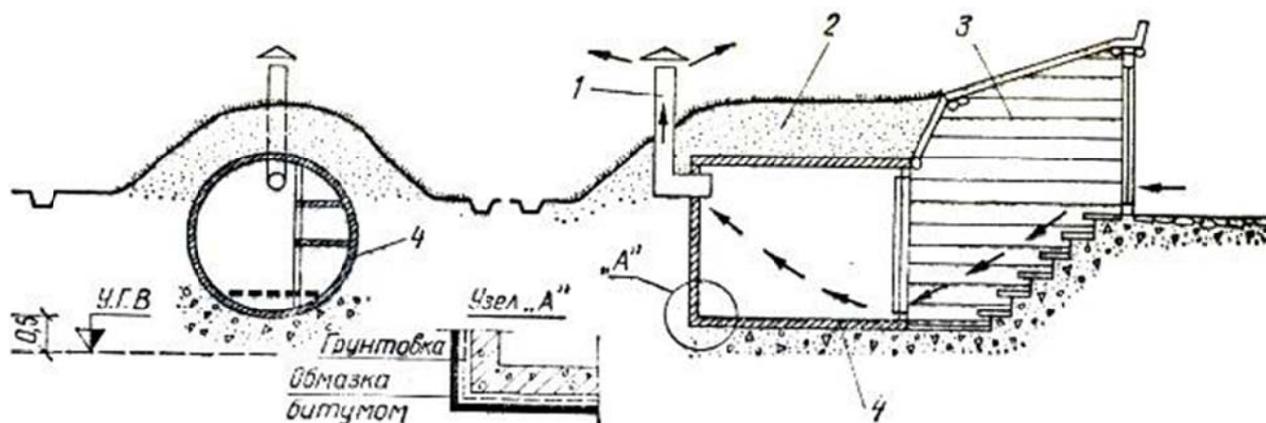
Погреб из железобетонных колец: 1 — вытяжка; 2 — обваловка грунтом; 3 — входной тамбур; 4 — бетонные кольца
